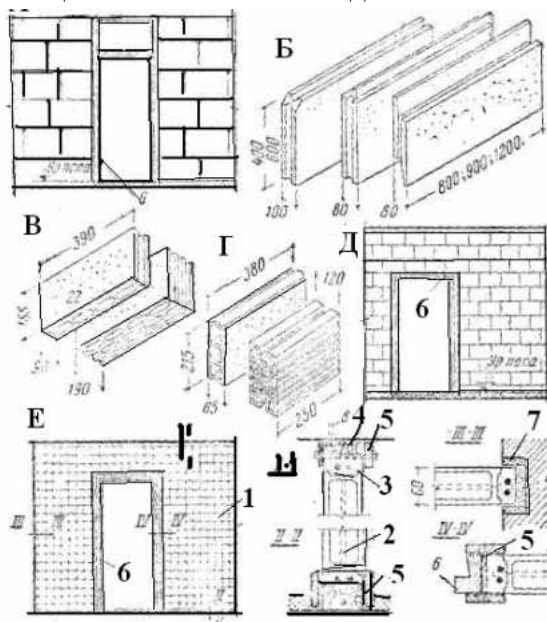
Дрібнозбірні та стеклозалізобетонні перегородки: А – із гіпсових або пенобетонних блоків; Б – гіпсові плити армовані рейками; В – пустотілі гіпсові камені; Г – пустотілі керамічні камені; Д – перегородка із пустотілих гіпсових плит; Е – стеклозалізобетонна перегородка; 1-склоблоки; 2-арматура; 3-цементний розчин; 4-конопатка; 5-дерев'яна розкладка; 6-дверна коробка; 7-прокладки
